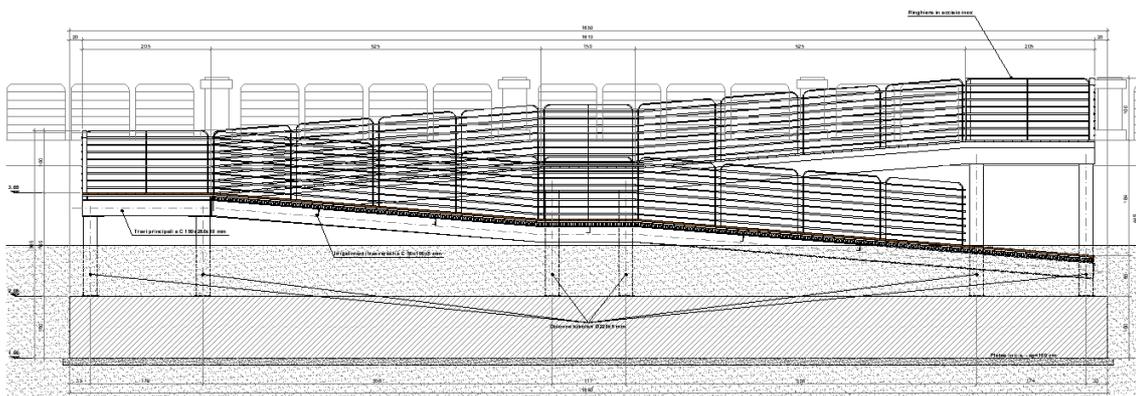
Sezione longitudinale tipo blocco rampe di accesso alla spiaggia
